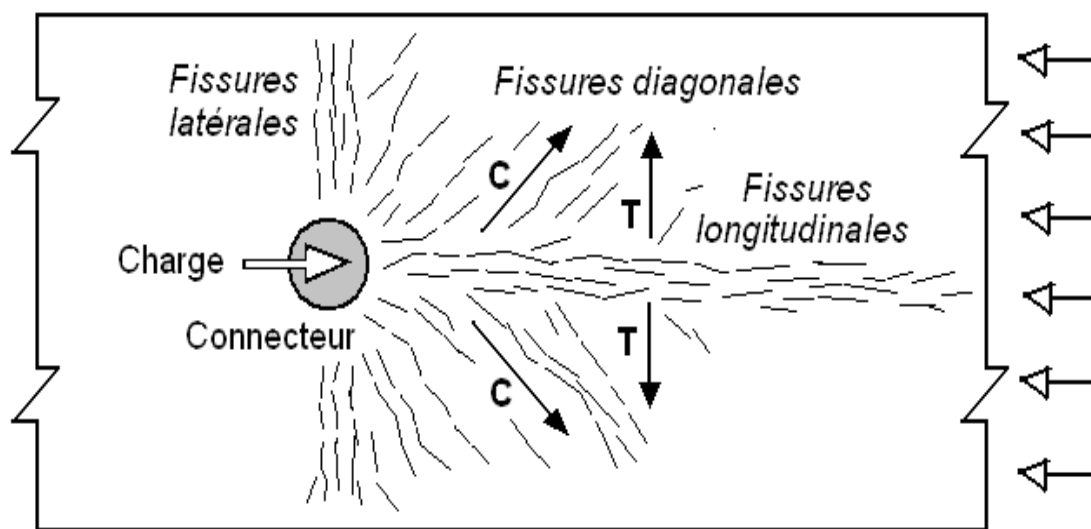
Types de fissures produites par la poussée du connecteur
